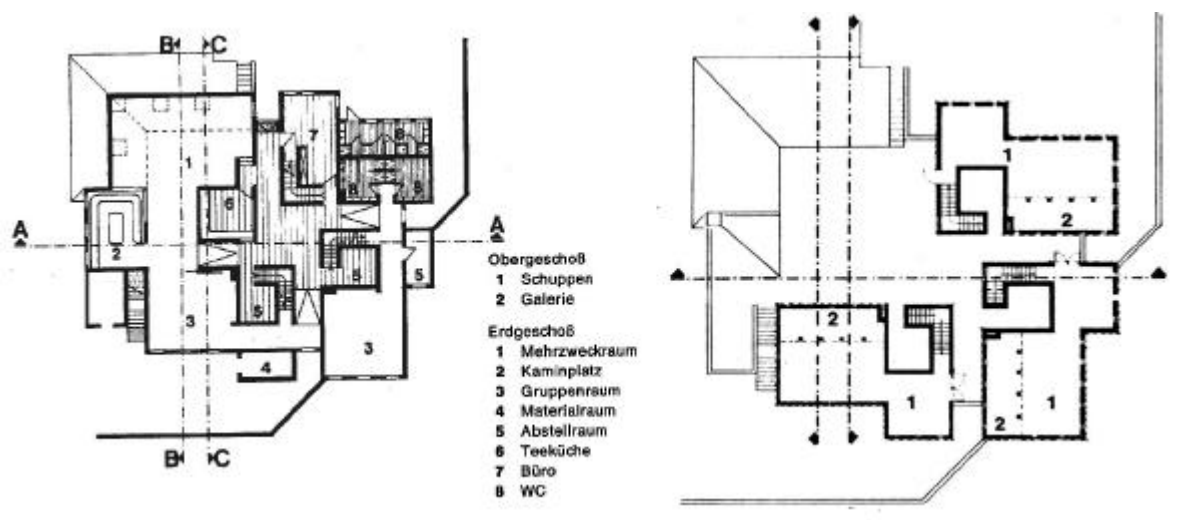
Spielhaus für einen Abenteuerspielplatz in West-Berlin, Grundrisse Erdgeschoß, Obergeschoß
